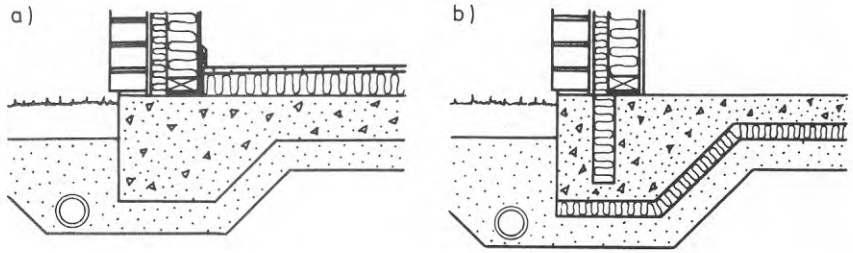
Principfigur utvisande alternativa placeringar av värmeisoleringen vid grundläggning med platta på mark.
